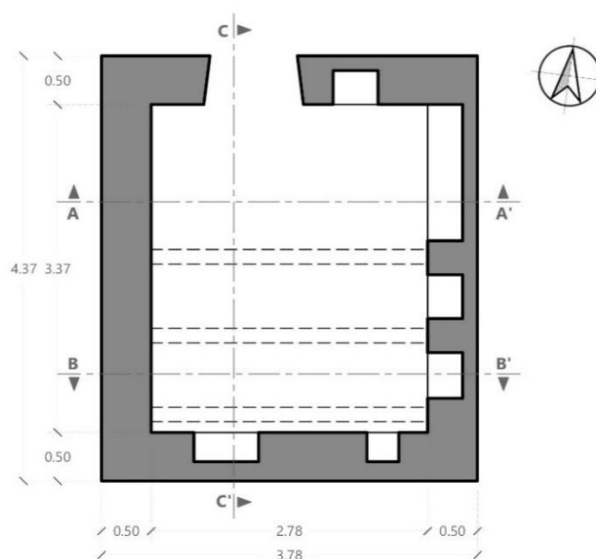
Planta arquitectónica. Casa de Piedra, ejemplo 1. Fuente: Elaboración propia.
